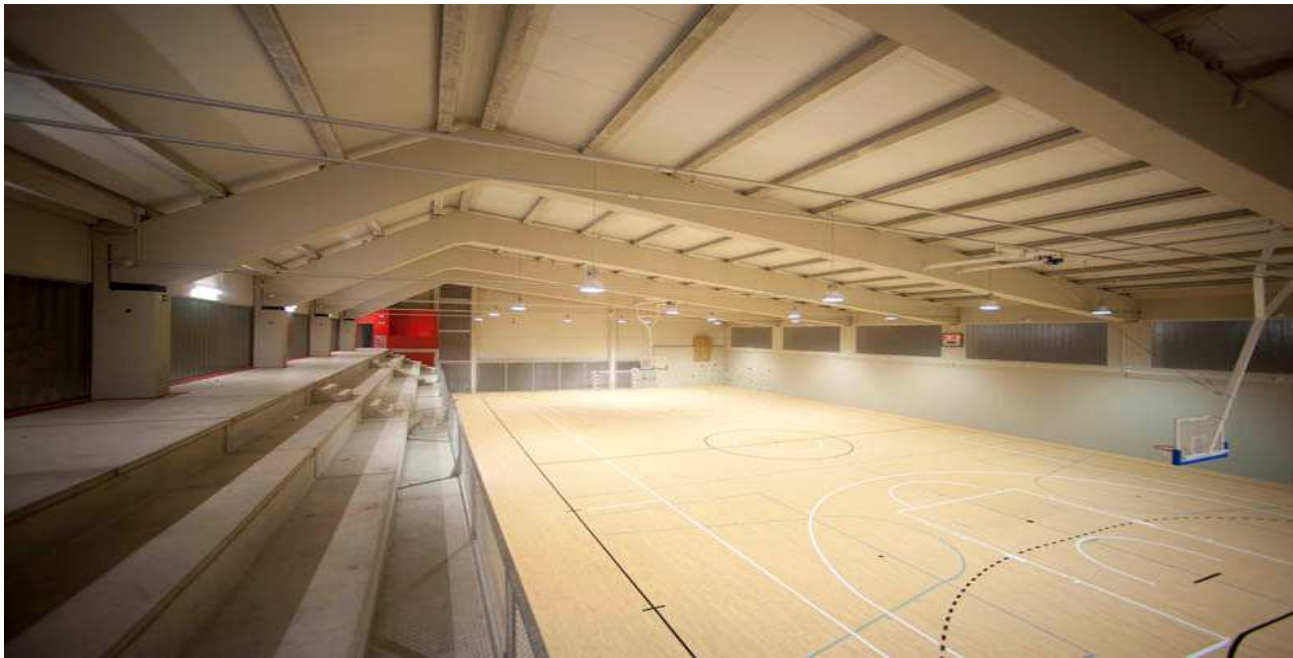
Detalle de las vigas de cubierta del Pabellón Polideportivo de Barakaldo (Vizcaya). Fuente: www.tecnyconta.es
